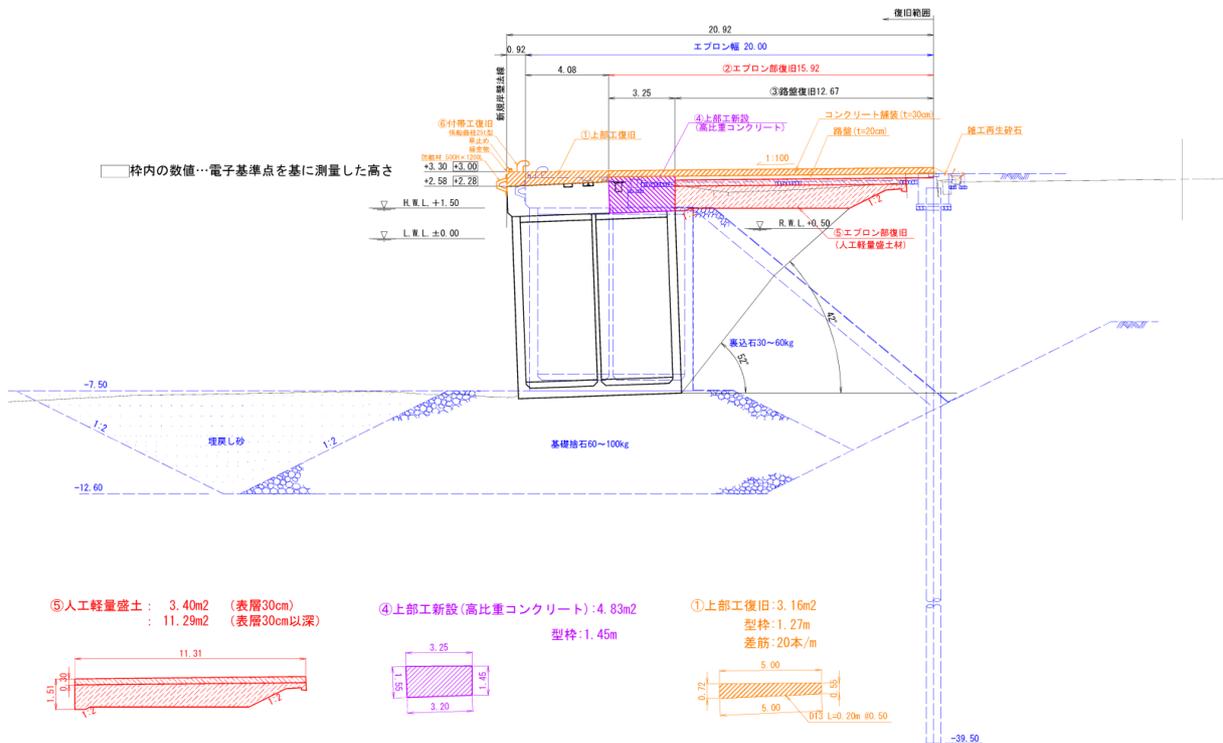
No.9 日立港区_第4ふ頭地区 4-C 岸壁 (-7.5m) の断面図 (復旧後)
